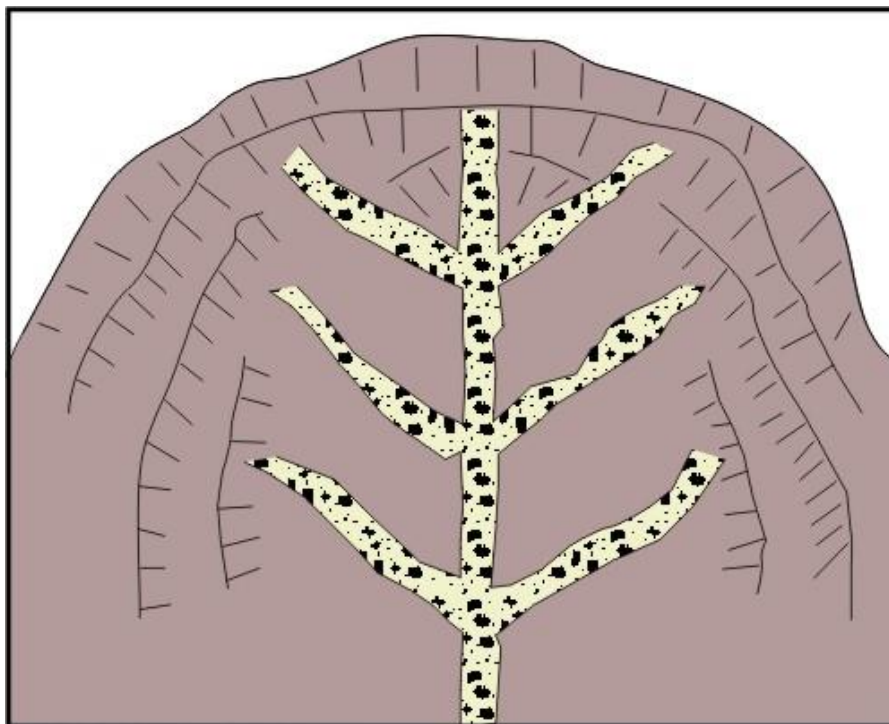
Drenaje tipo espina de pescado (tomado de Ingemmet, 2000)
